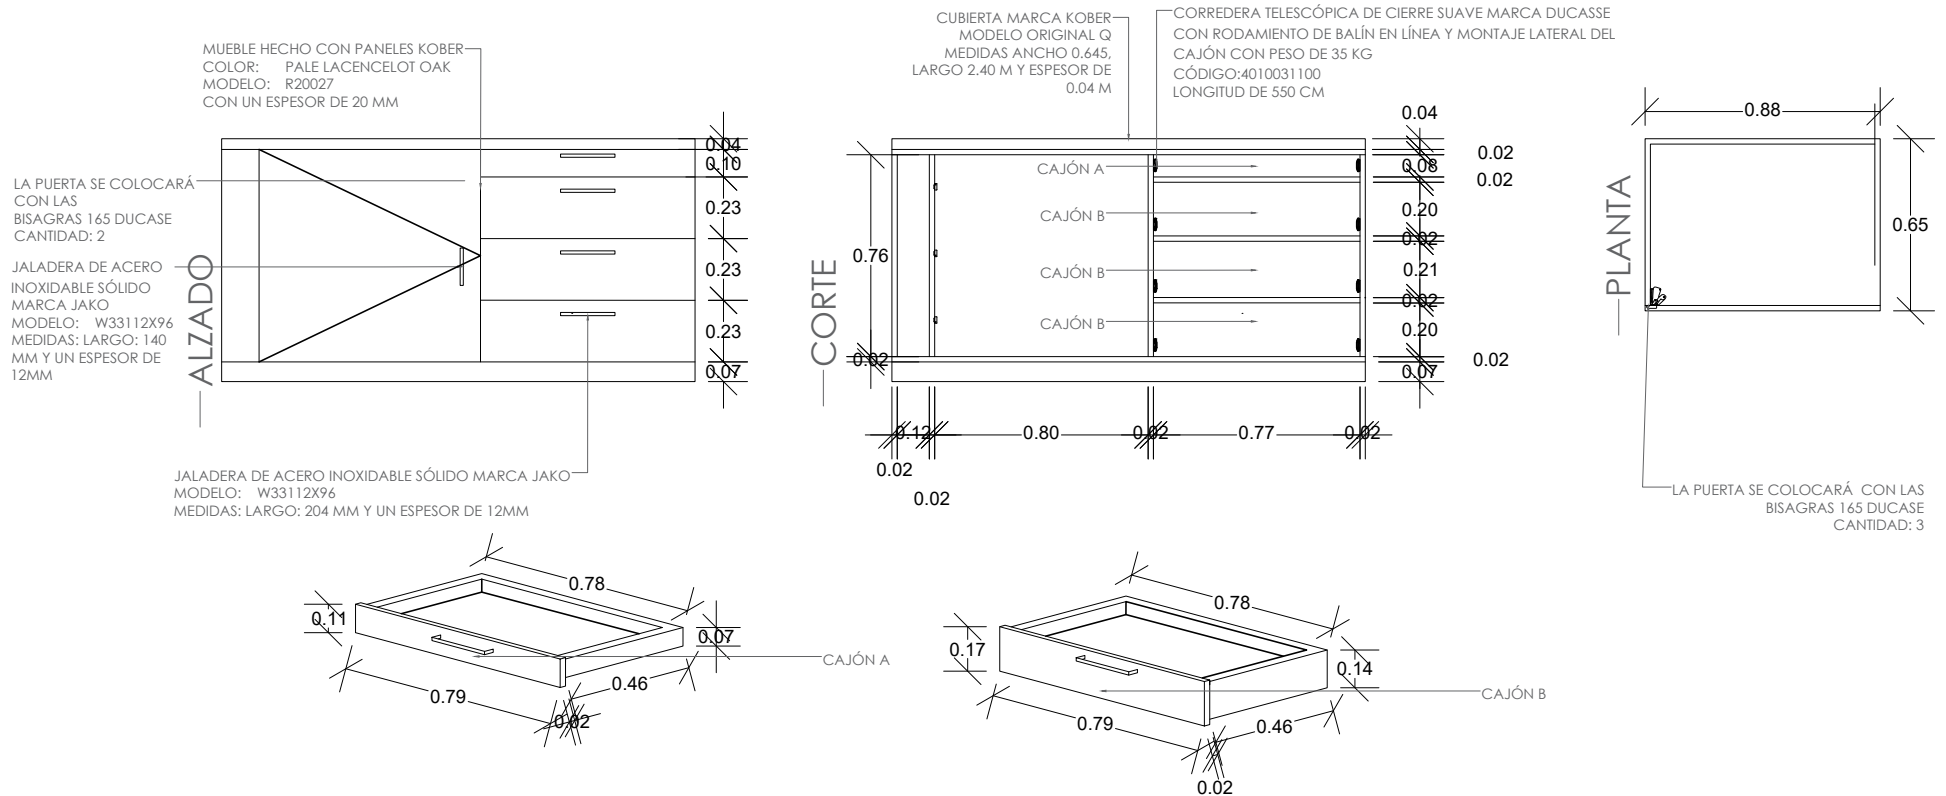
Imagen objetivo vestidor. Elaboración propia. 2022
